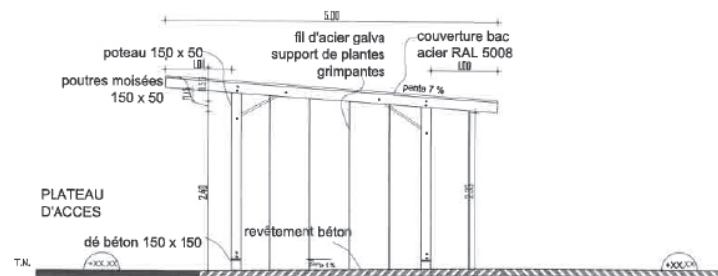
Exemple constructif (document non contractuel) dans le cas d'une construction d'un préau
